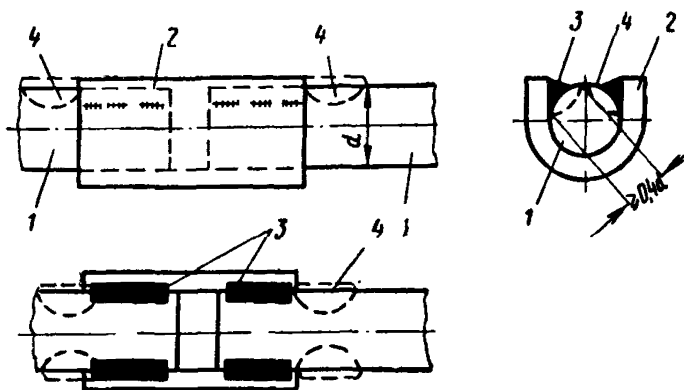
Конструкция соединения стержней для ванно-шов-ной сварки
